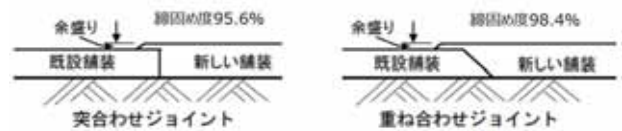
施工ジョイントの形式 (空港土木施設施工要領に加算)
